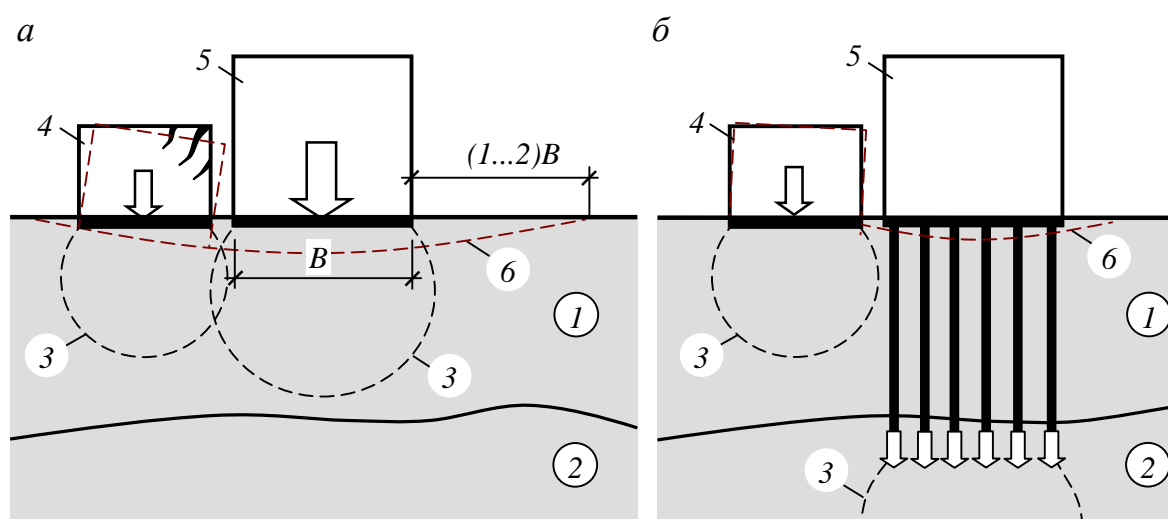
Схемы влияния на существующее здание нового здания на плитном фундаменте (а) и свайном фундаменте (б): 1 – среднесжимаемый грунт; 2 – малосжимаемый грунт; 3 – зона развития напряжений; 4 – существующее здание; 5 – возводимое здание; б – воронка оседания поверхности, вызванная нагружением фундамента нового здания (Мангушев Р.А., Ершов А.В., Осокин А.И., 2010).
